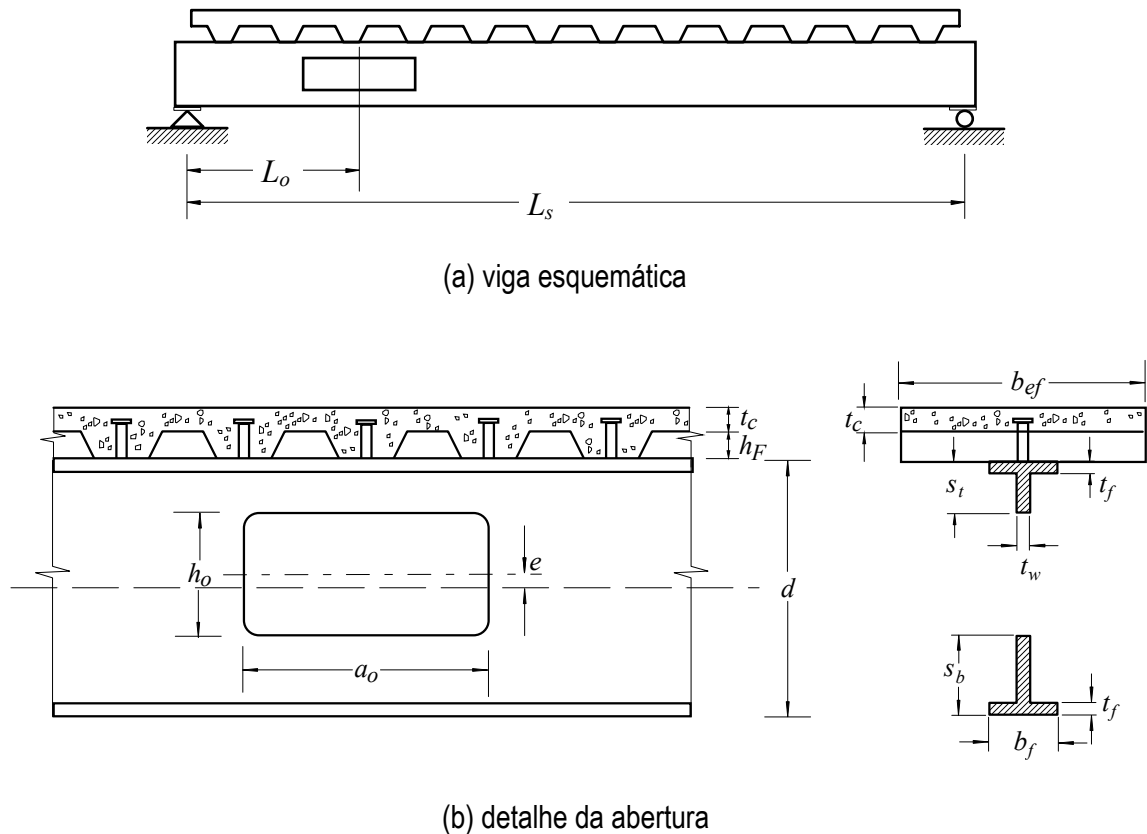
Viga Mista com abertura na alma (Donahey, 1987).
